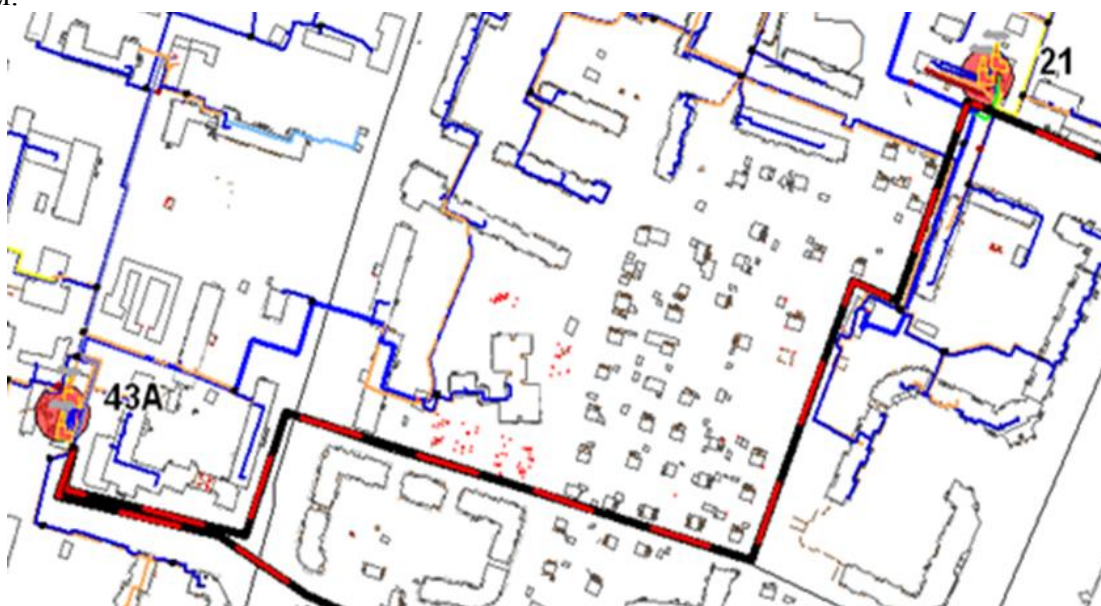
Схема прокладки трубопровода от котельной №21 до котельной №43а
